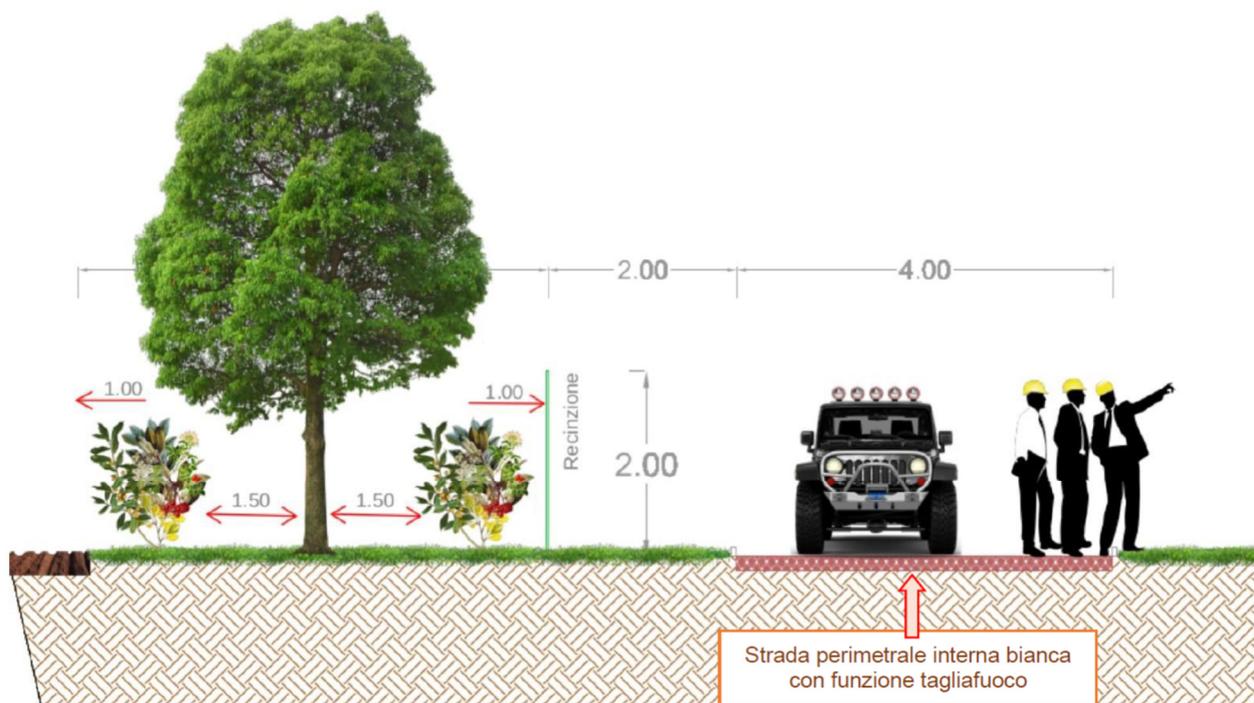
Sezione tipo della fascia tampone perimetrale
